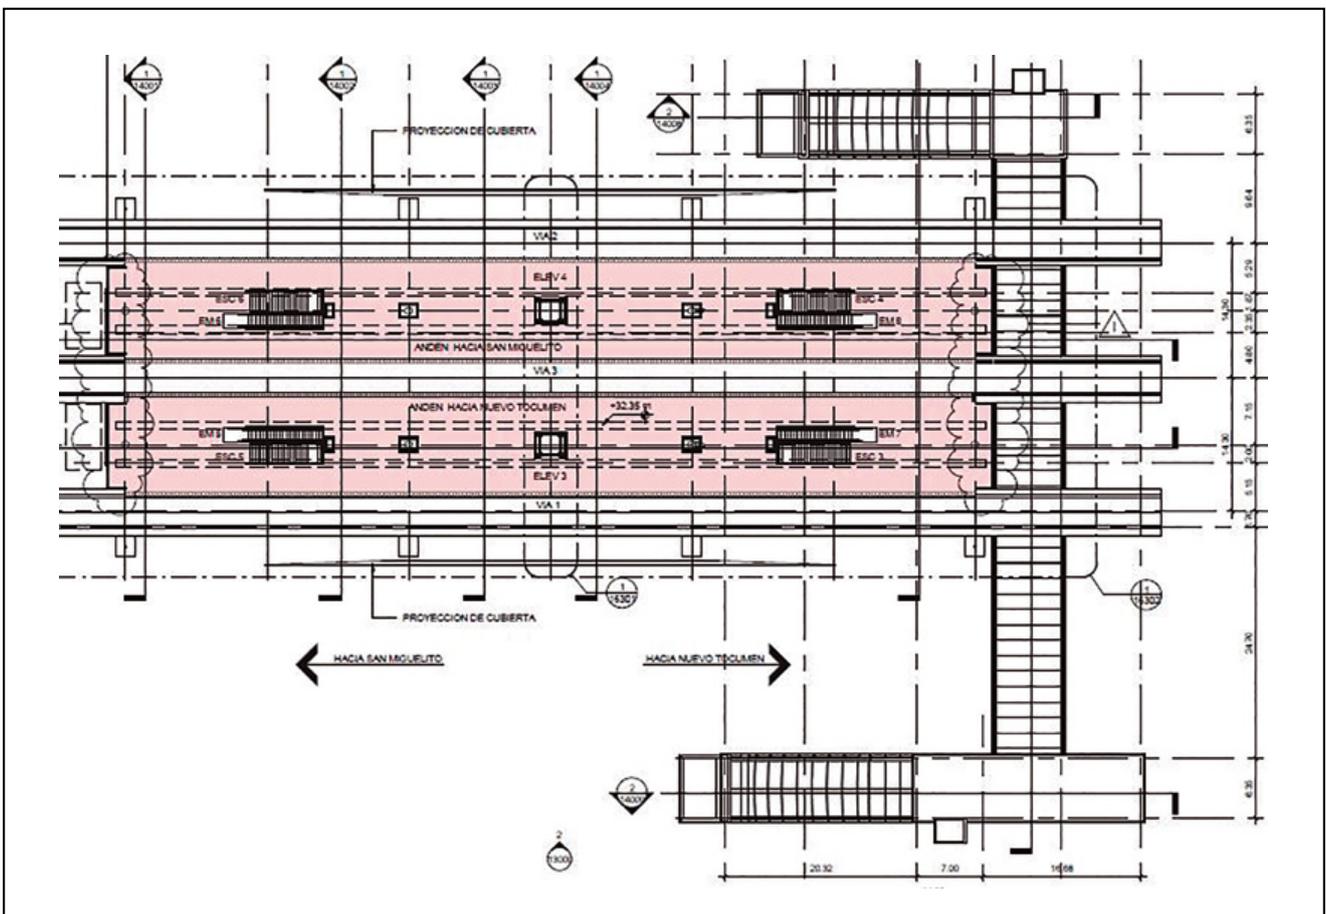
Estación Corredor Sur – Vista en planta del nivel andén y sus tres vías.
